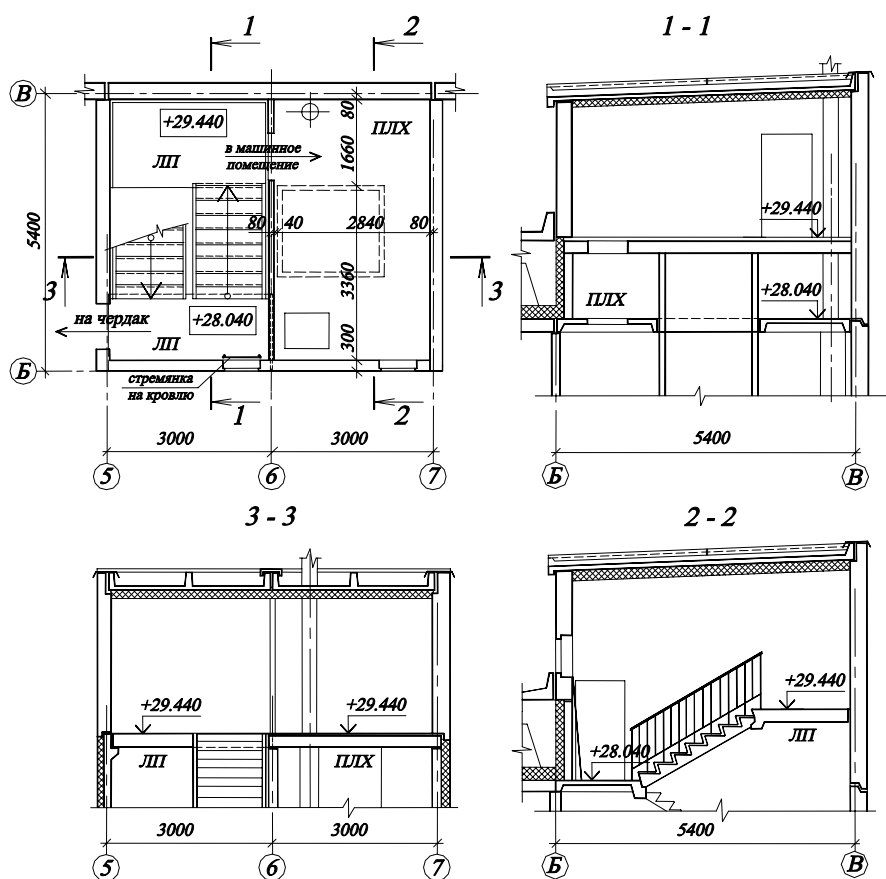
Конструкции перекрытия и покрытия машинного отделения лифта десятиэтажного дома
